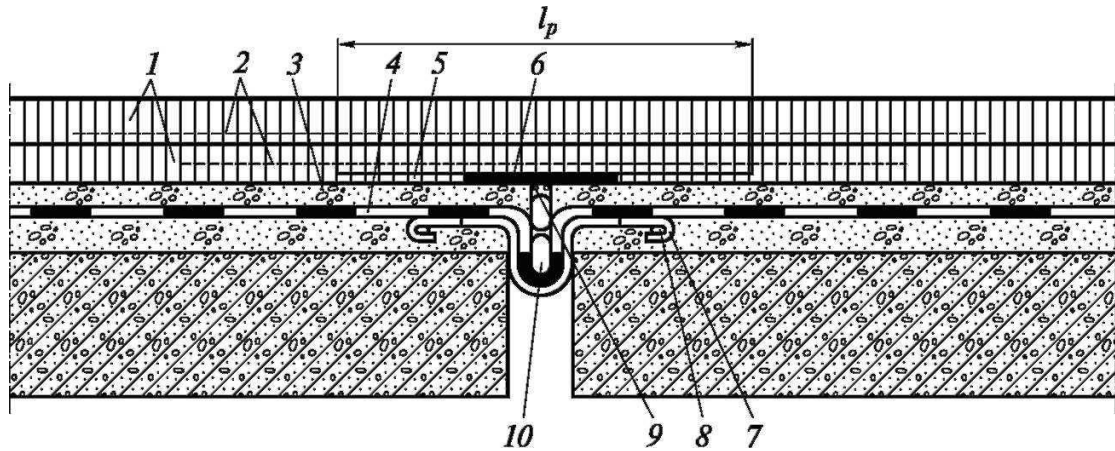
«Конструкція деформаційного шва закритого типу з армованим асфальтобетонним покриттям: 1 – покриття; 2 – армуюча сітка; 3 – захисний шар; 4- гідроізоляція; 5– відокремлююча прокладка; 6 – перекриття зазору; 7 – компенсатор; 8– анкерний стрижень; 9 – мастика; 10 – пористий заповнювач» [32]
